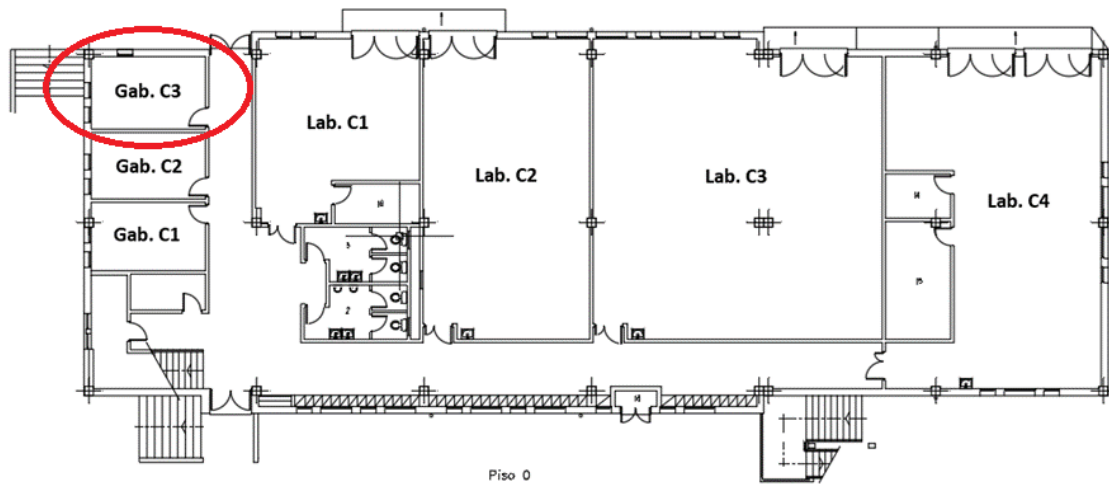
Planta do Piso 0 com localização do Gabinete C3 destacada.
